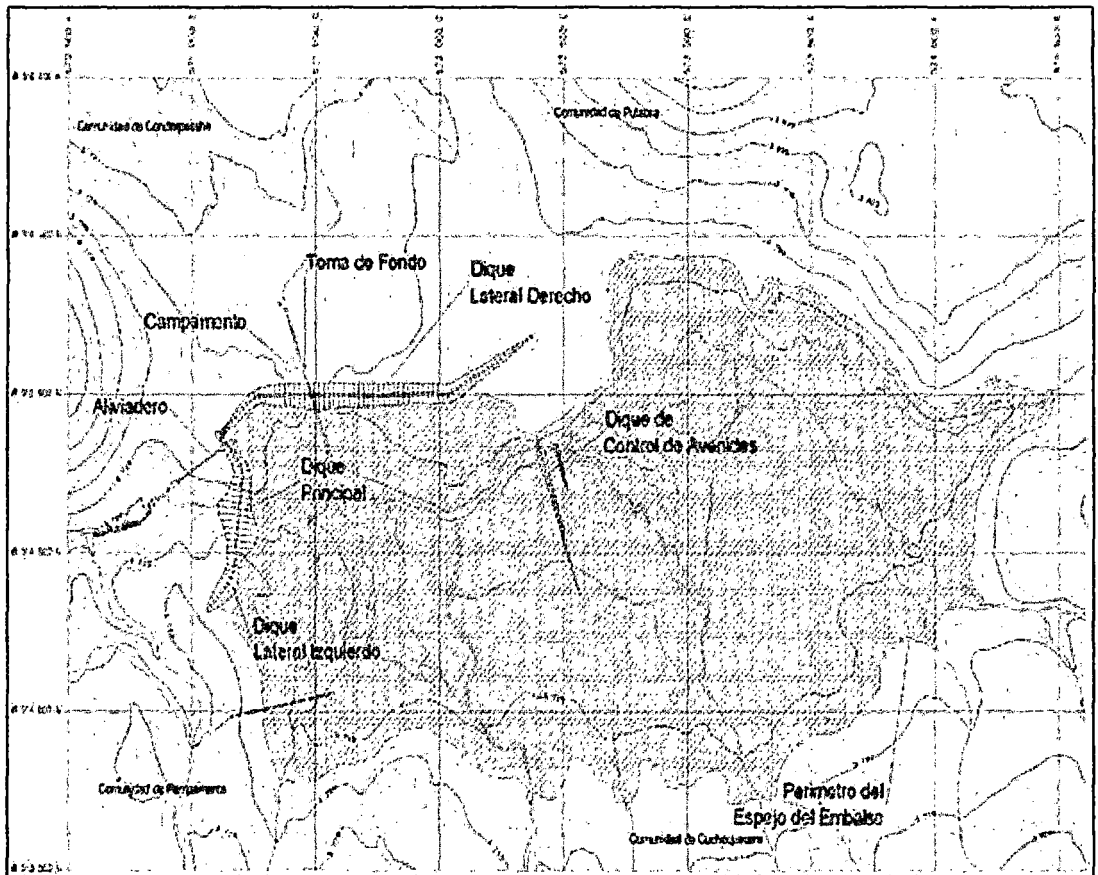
Vista en planta de la presa Cuchoquesera
